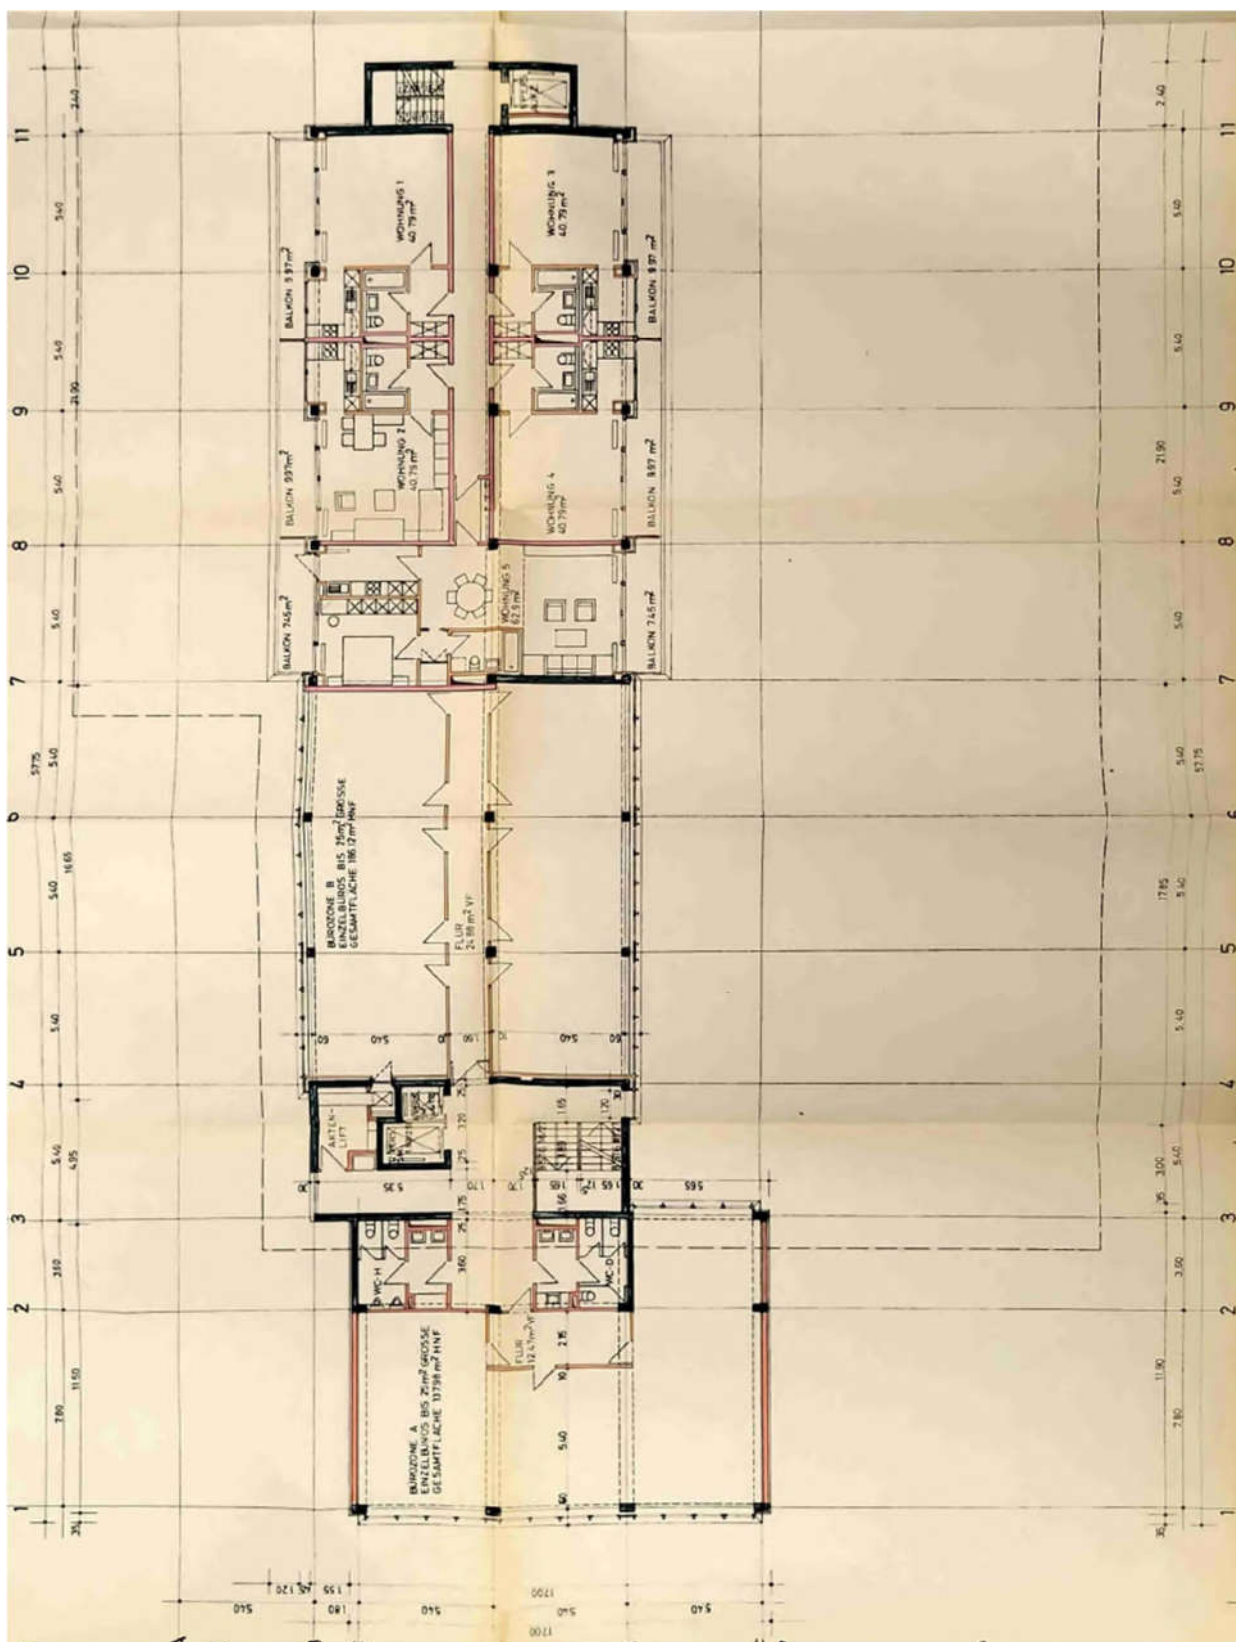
Grundriss 2. Obergeschoss
